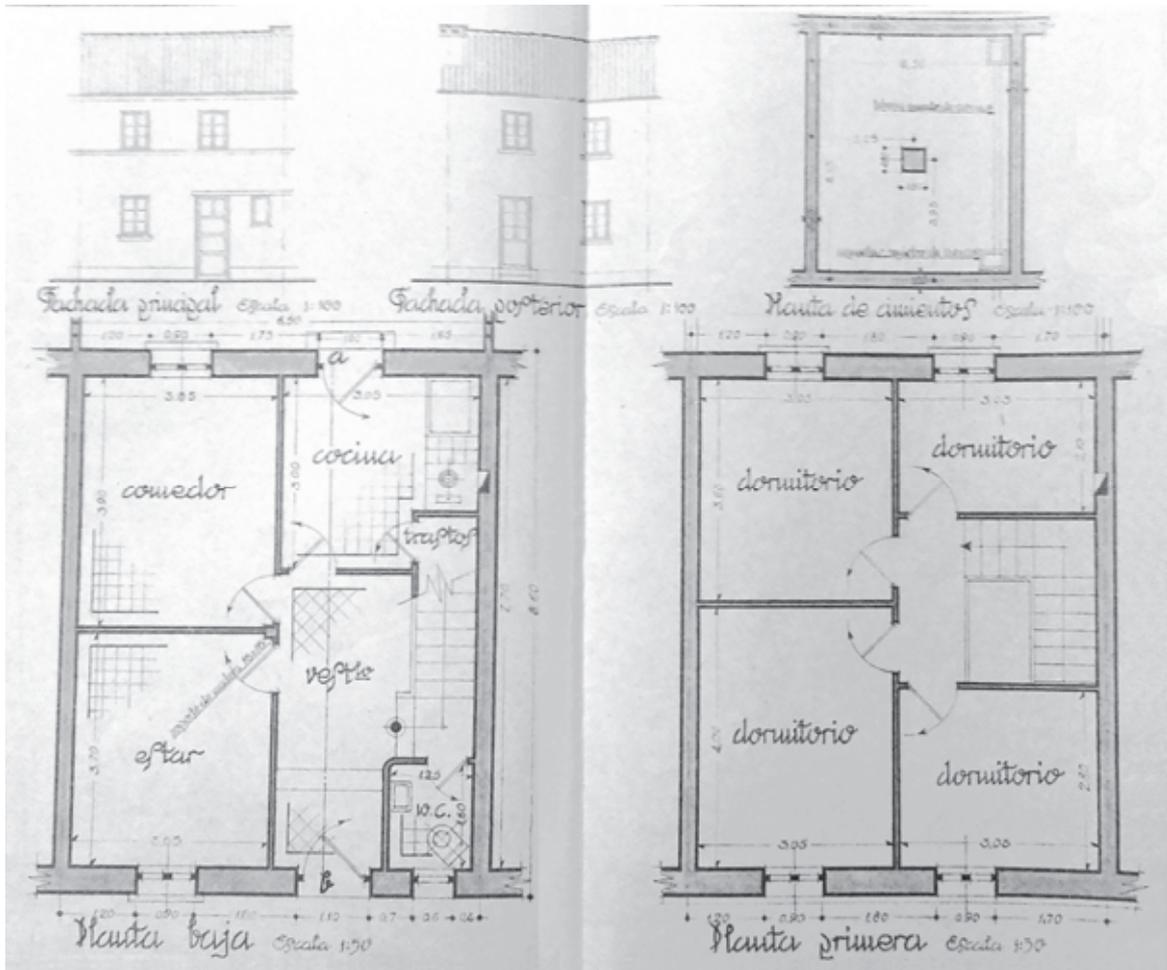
Detalle del plano de la vivienda del tipo 3, del «Proyecto de viviendas protegidas para la Obra Sindical del Hogar en Roa de Duero (Burgos)», firmado por el arquitecto Olano en agosto de 1942. Fuente: ACFomJCyL, caja 163
